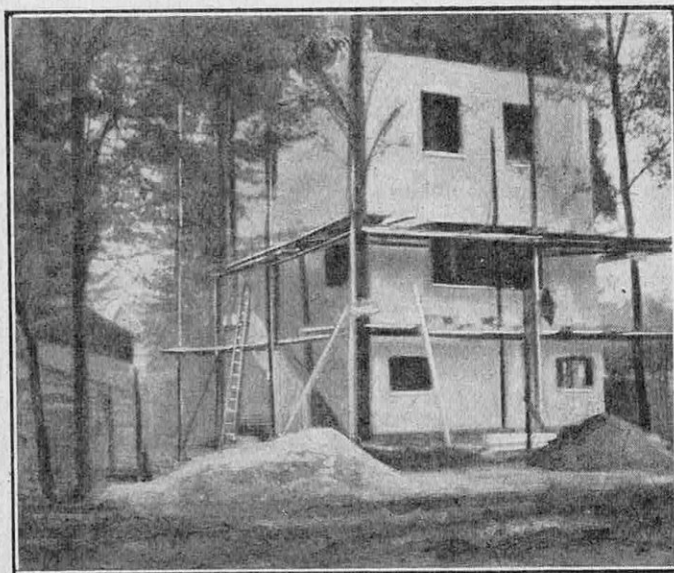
CONSTRUCTION D'UN PAVILLON DE STYLE MODERNE EN BÉTON ARMÉ
